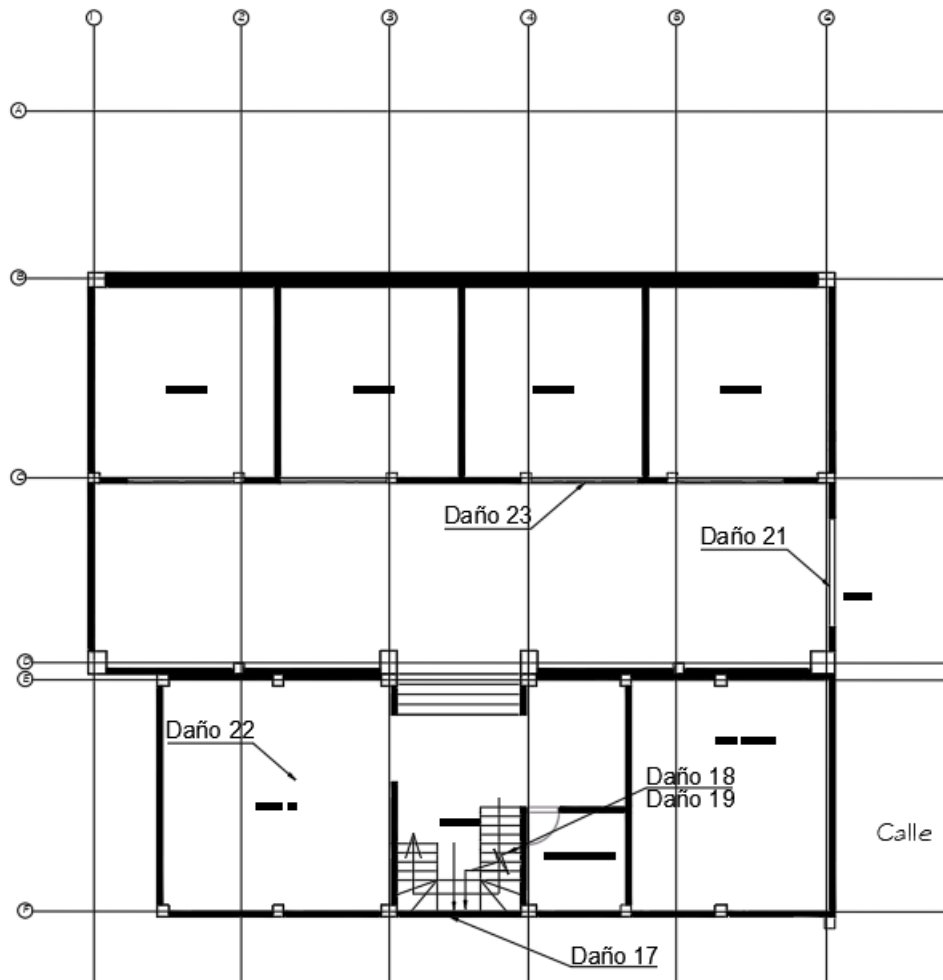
Localización de daños planta cimentación. Fuente: Propia
